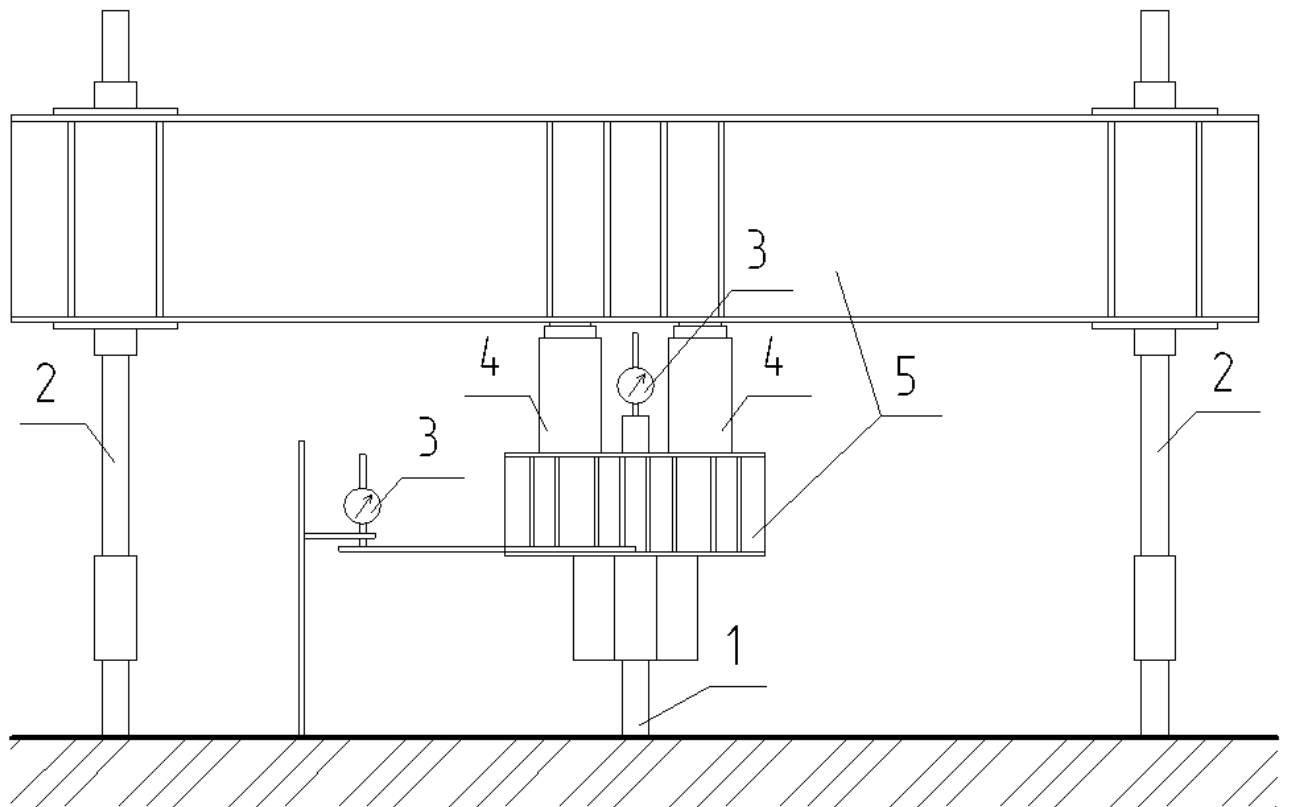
Схема установки для испытания сваи вдавливающей нагрузкой.
